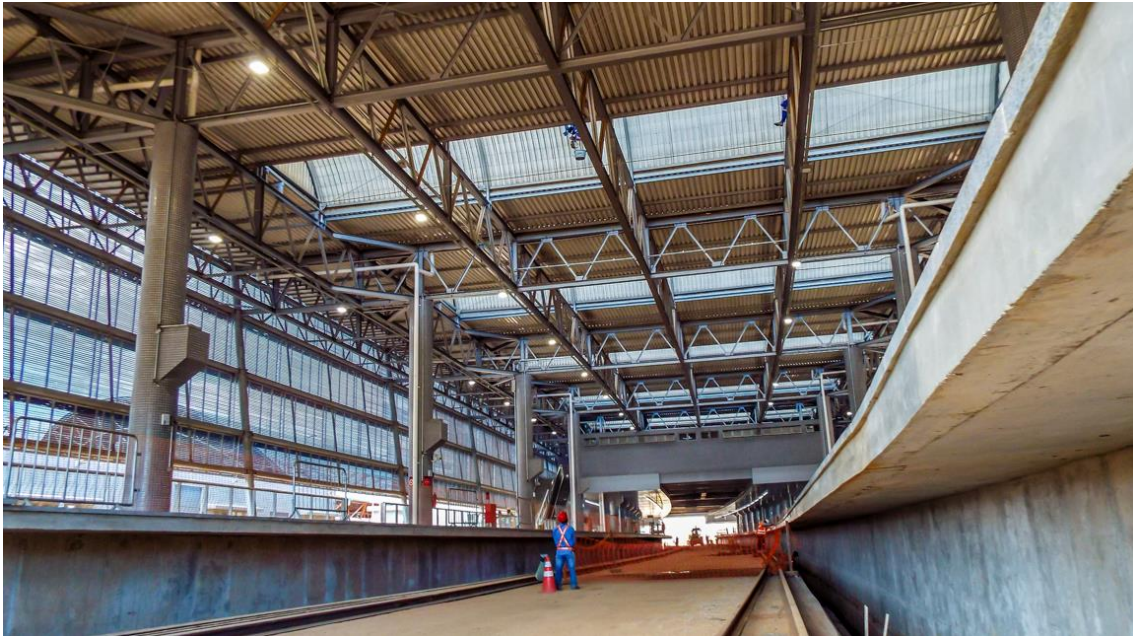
Escavação da via, Estação Acesso Norte – Linha 2 (Fonte: acervo JBMC
